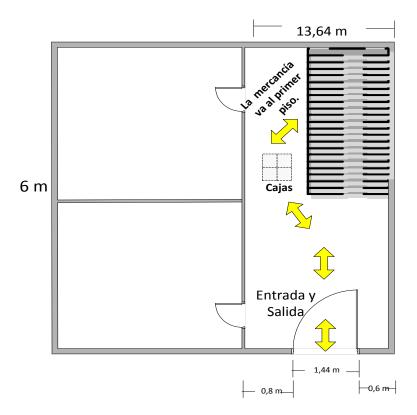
VISTA DE PLANTA DE PLANTA BAJA (PB)
